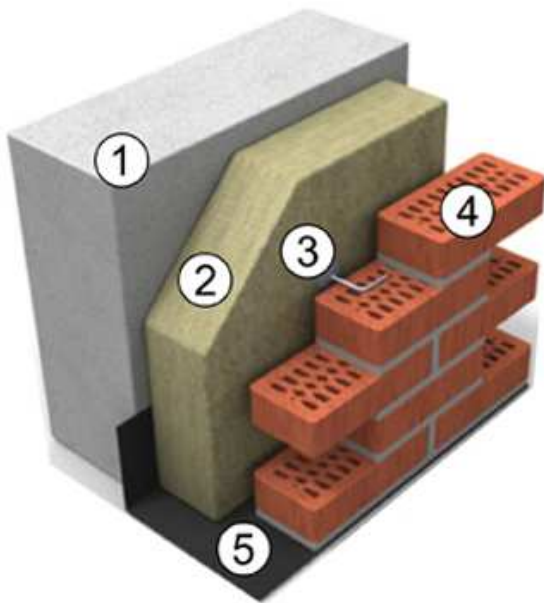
Варіанти кріплення цегляного облицювання до фасада
